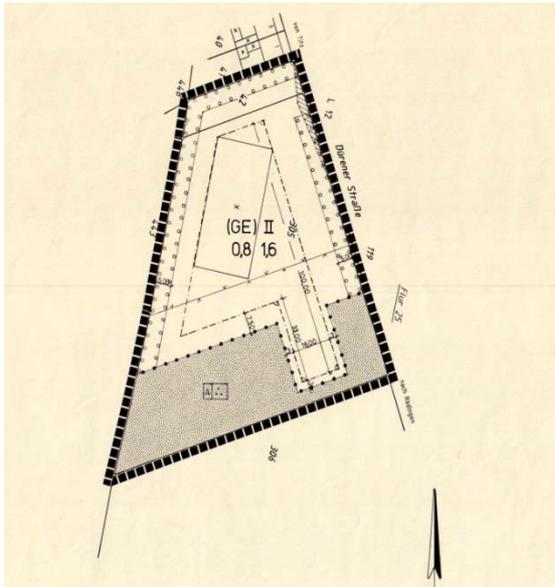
Bebauungsplan Nr. 14 in Titz Ameln
